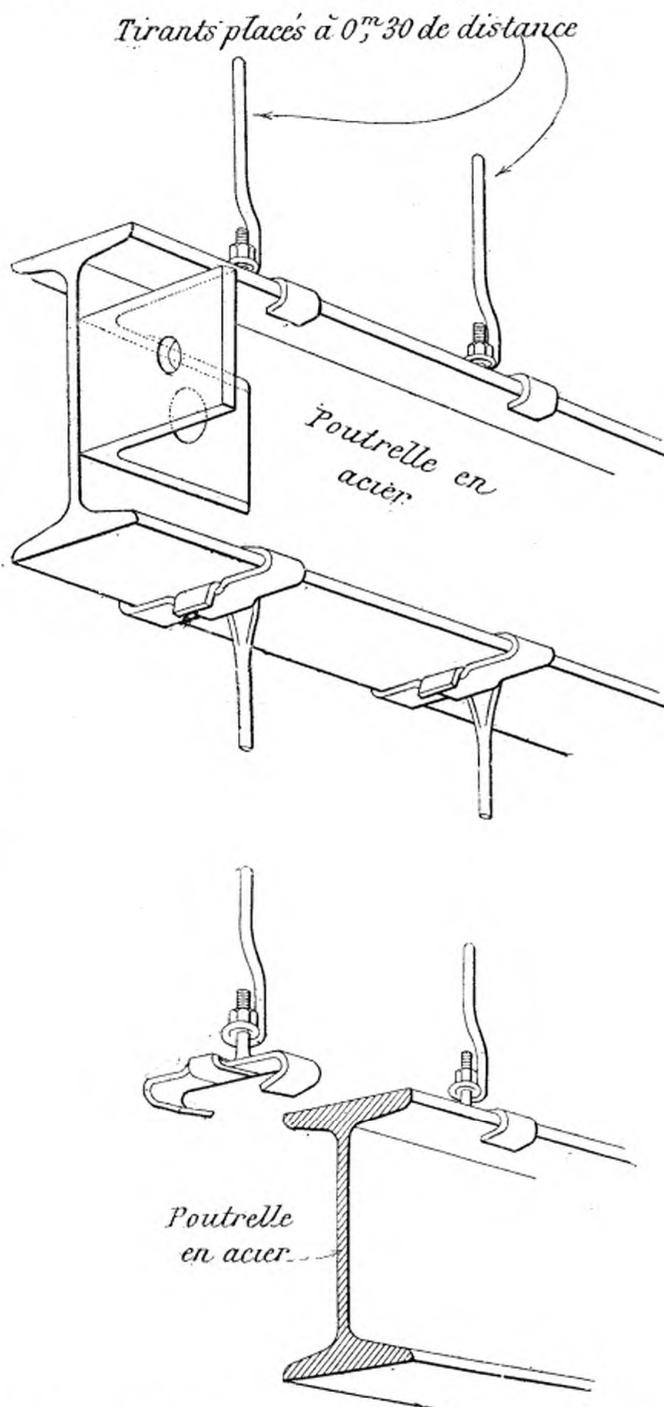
Poutrelles pour planchers et crampons d'attache pour cloisons.
